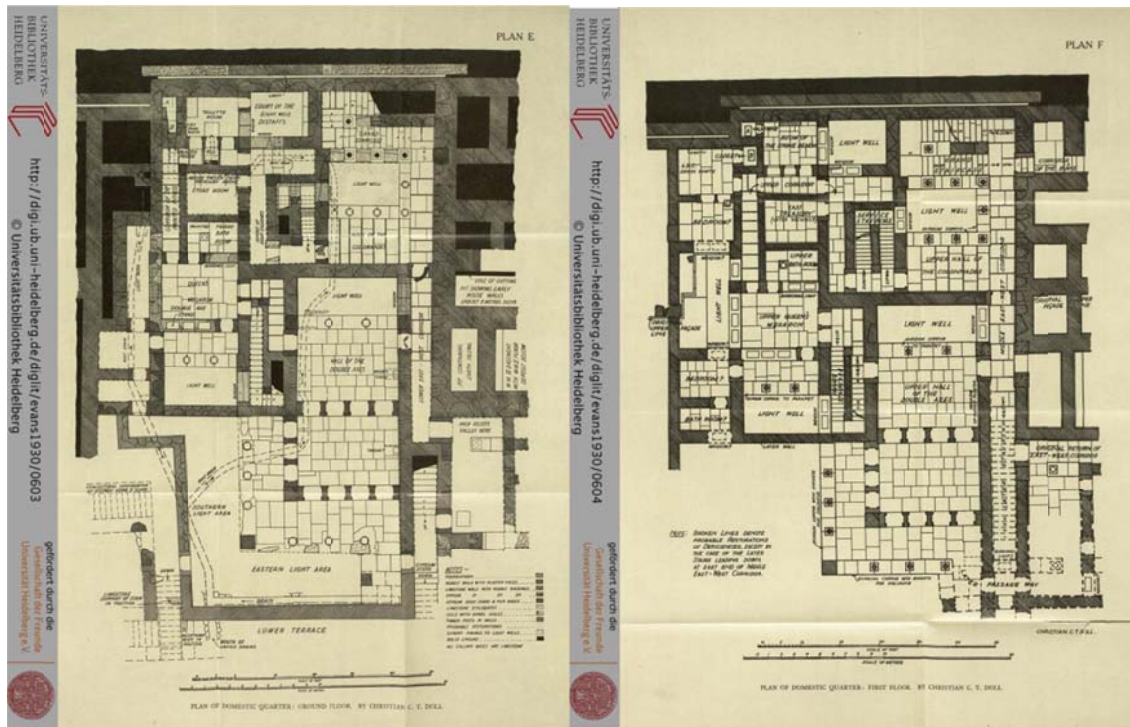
Plans de rez-de-chaussée et du premier étage des appartements résidentiels d'après Arthur Evans
